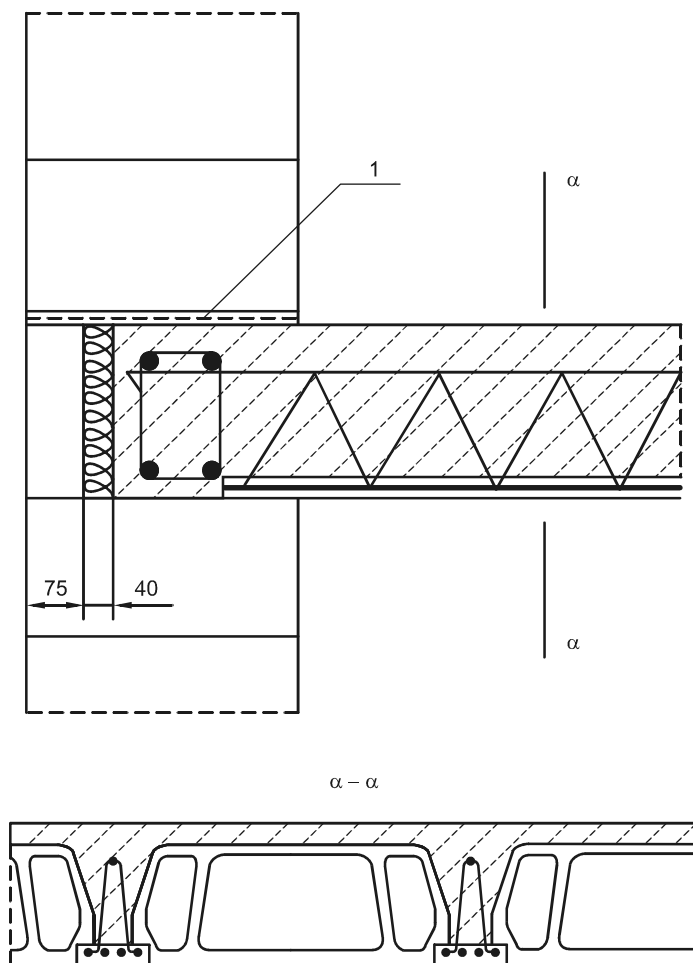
, а. Узлы сопряжения стен с ребристыми перекрытиями:
